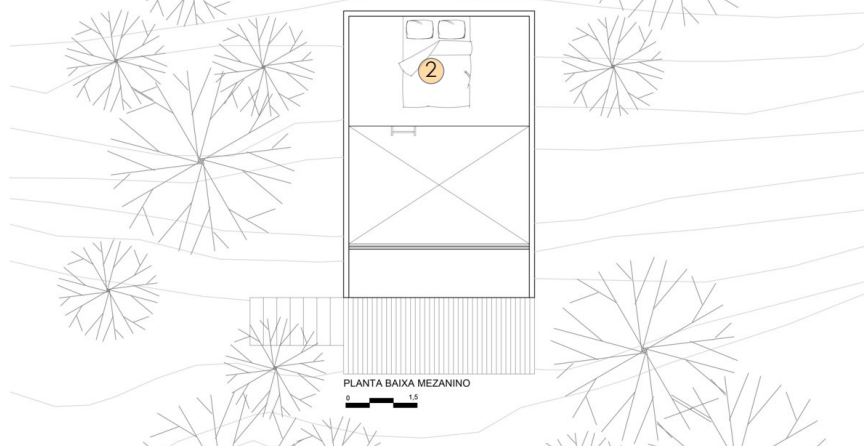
Planta mezzanine. Fuente: A+R ARQUITETURA, 2020
